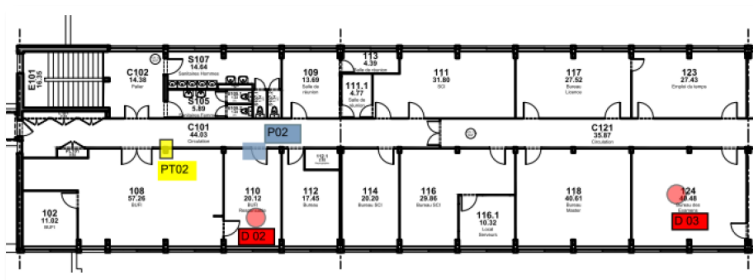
Localisation de la zone sondée, vue en plan, bâtiment Ouest
